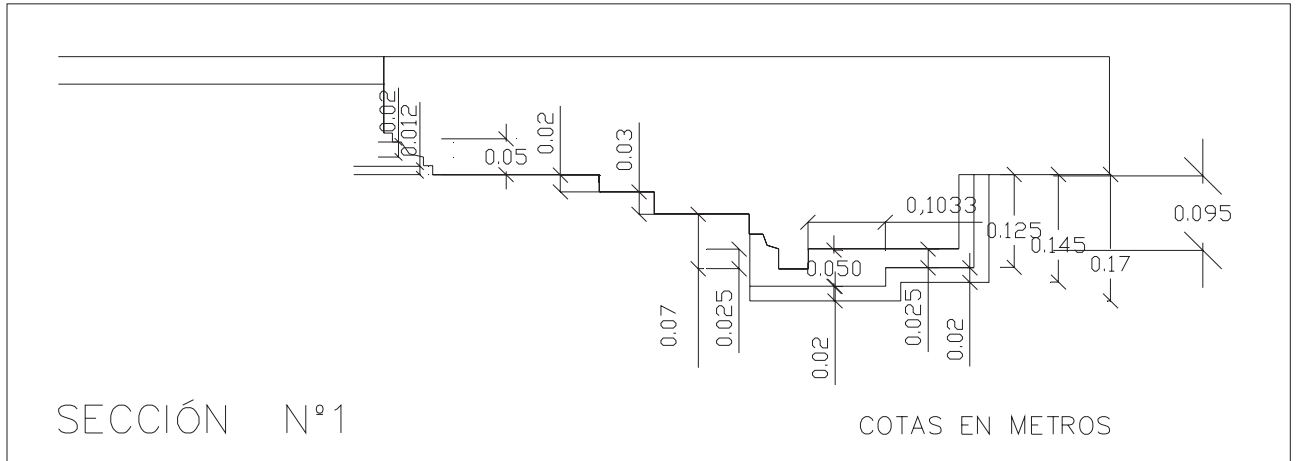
Plano de proyecto de la sección de las jambas de la portada de la fachada norte.
